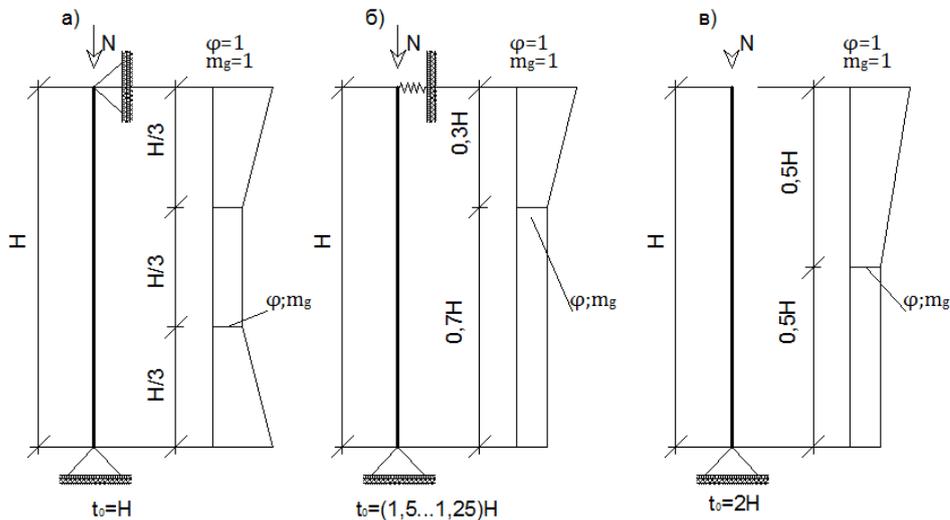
Значение m_g и ϕ по длине сжатых стен и столбов:
